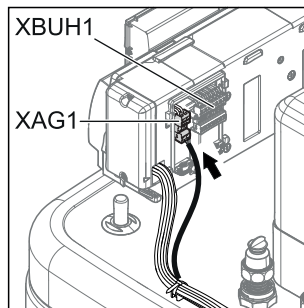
Elektrische Anschlüsse Gehäuserückseite (siehe Kap. 4.5.1) herstellen.
